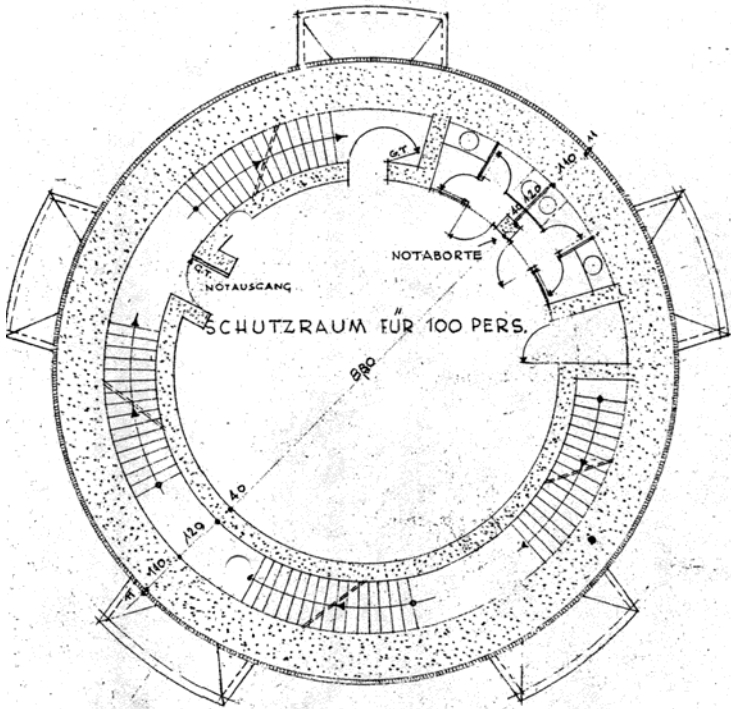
Erdgeschoss (Plan Denkmalschutzamt)
